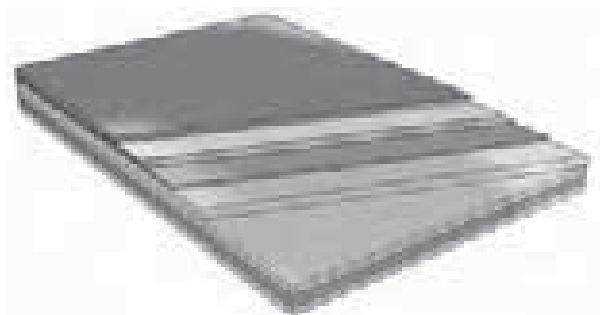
Elemento solaio preassemblato con pacchetto a secco.
